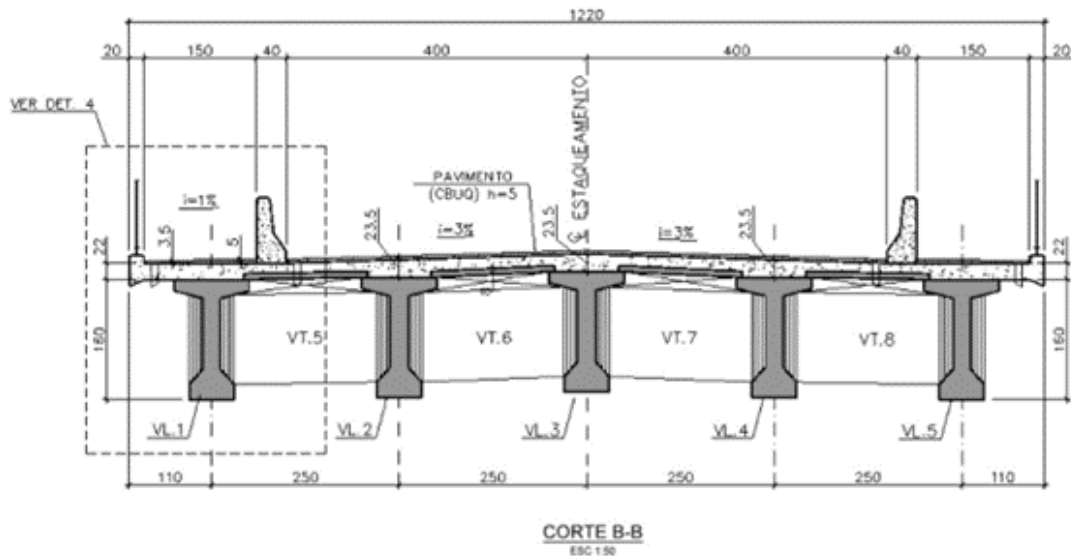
Seção transversal típica no trecho isostático (vigas pré-moldadas)
